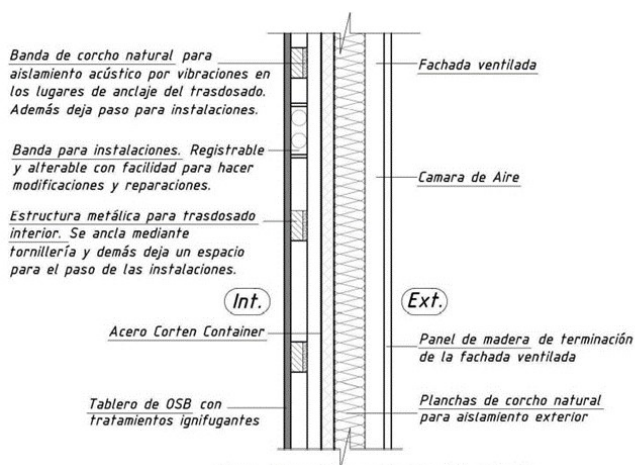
Detalle constructivo de aislamiento por cara exterior según solución adoptada. Fuente: Elaboración propia.
